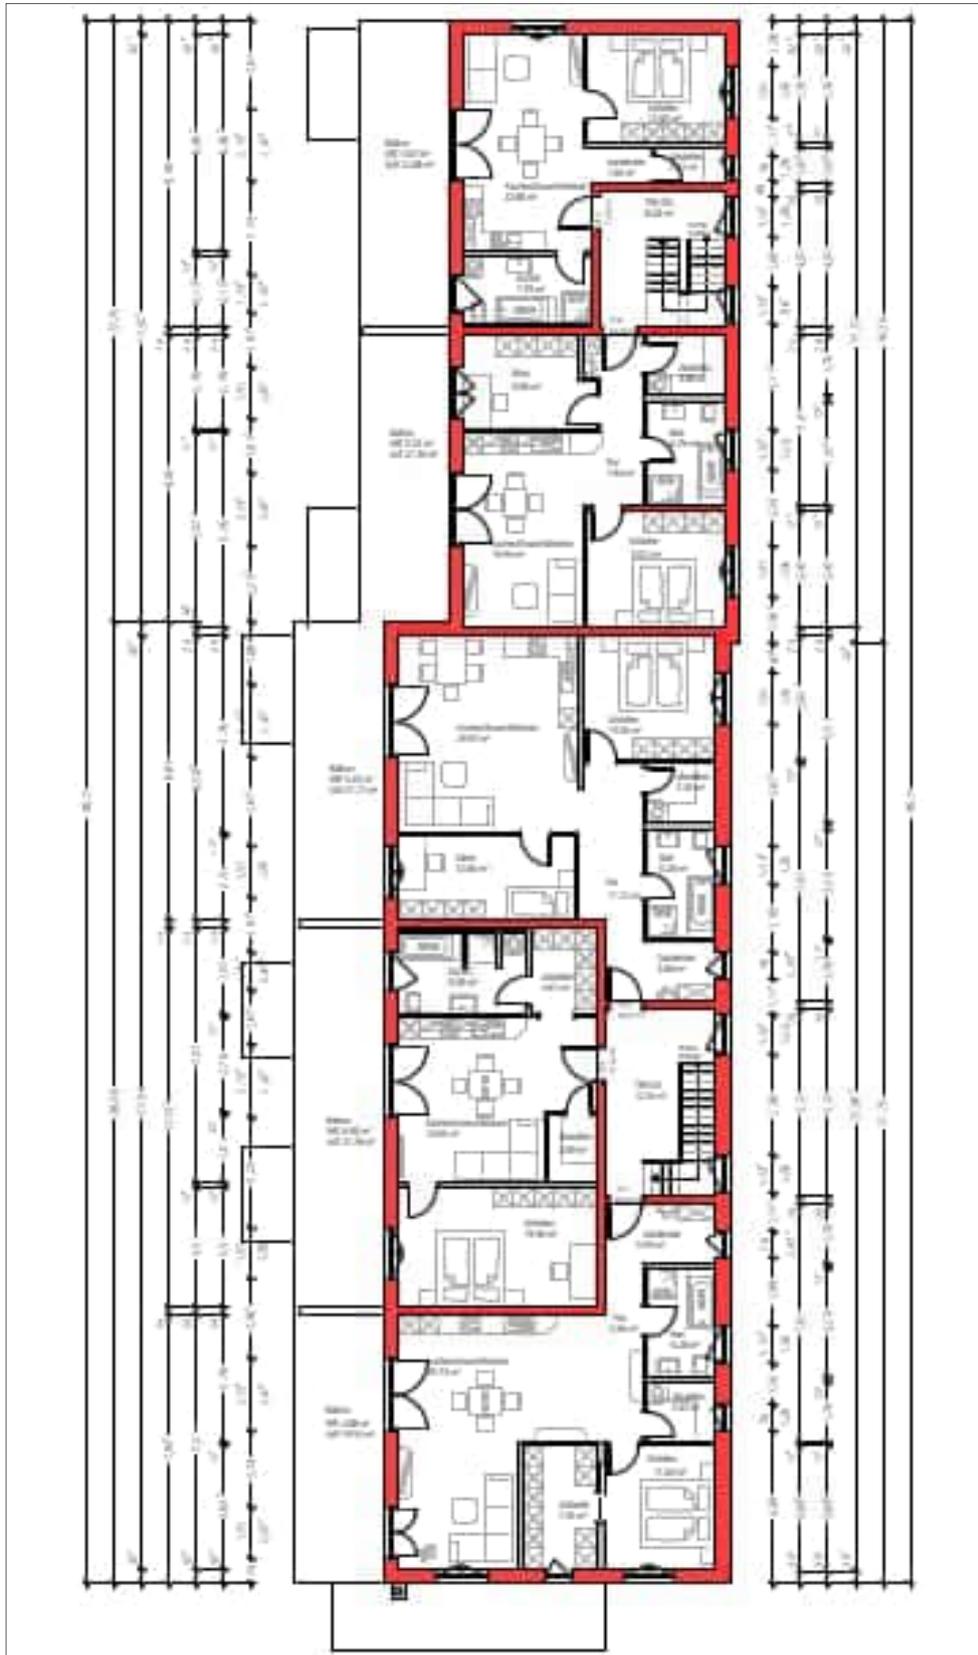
geplanter Grundriss im EG u. 1.OG "MFH Rössle" (Verfasser: IB Leis, Reichling)
